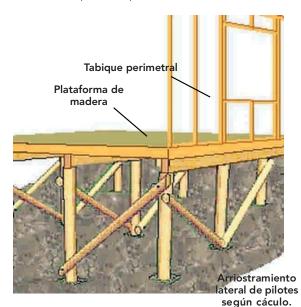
49 : Arriostramiento de pilotes según cáculo estructural.
